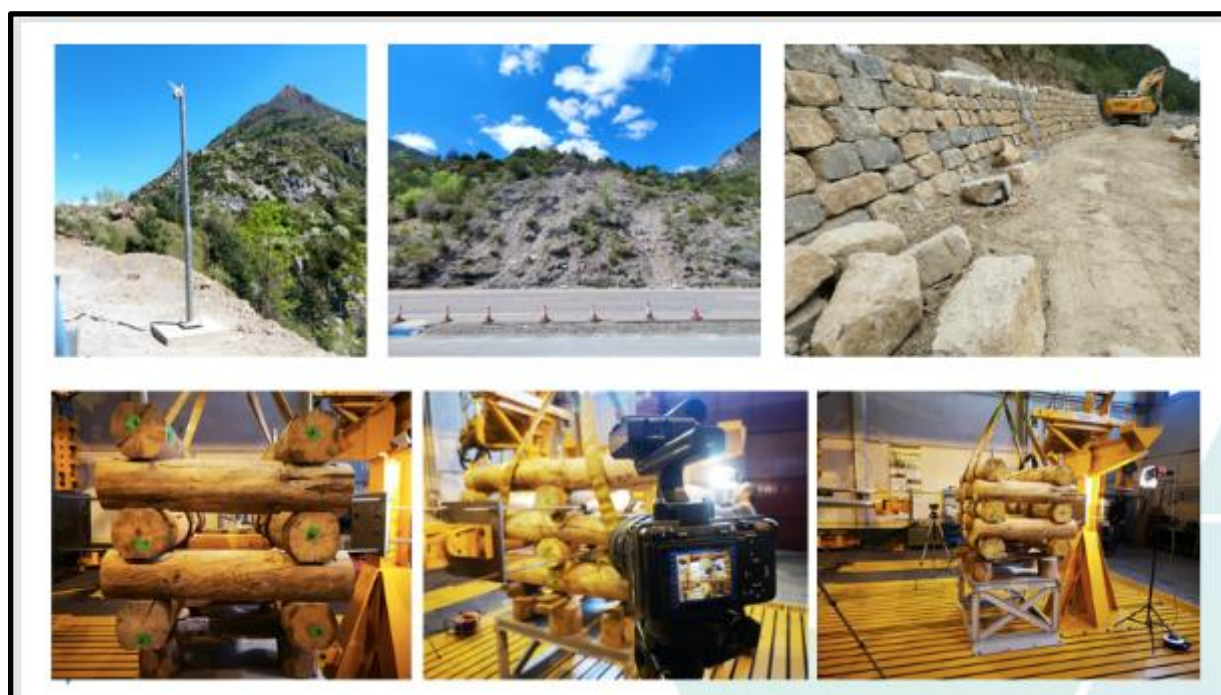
Ilustraciones de la aplicación del NBS en el emplazamiento de Santa Elena y de las pruebas de resistencia de la estructura en el laboratorio.
